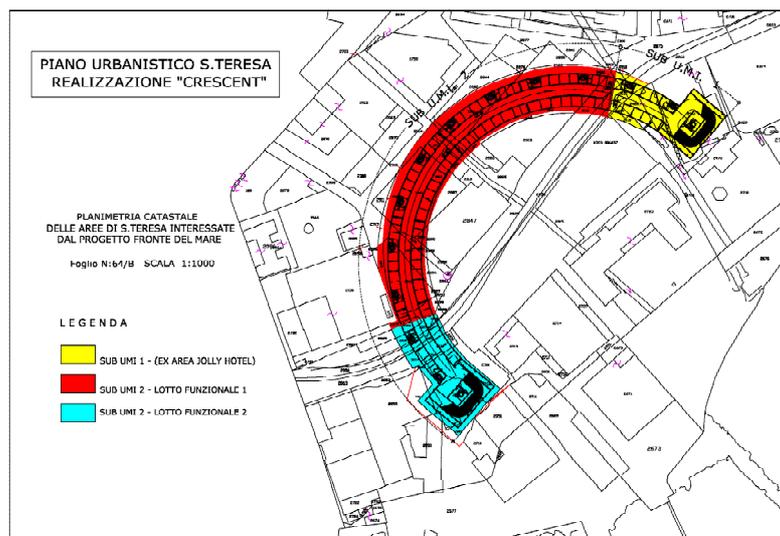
Piano urbanistico di Santa Teresa, Planimetria catastale con indicazione delle aree interessate dal progetto del Fronte mare
